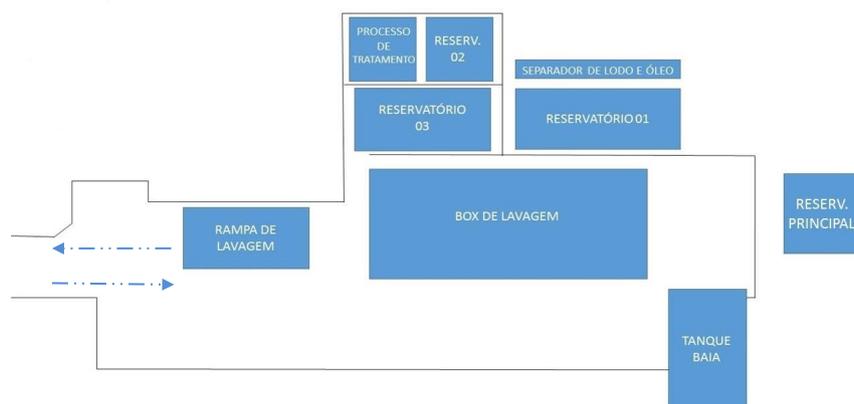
PLANTA DO POSTO DE LAVAGEM
